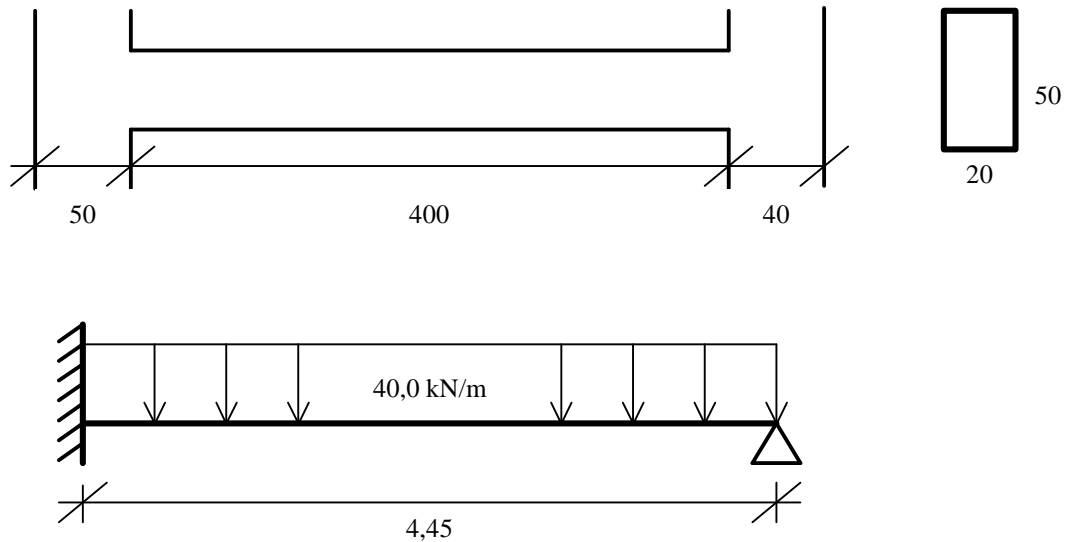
Dimensões e Carregamentos da Viga do Exemplo 5.
